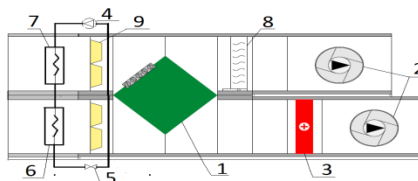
Приточно-вытяжная установка(VS-21-R-PH): 1- перекрестно-точный рекуператор; 2- вентилятор; 3- электронагреватель; 4- компрессор; 5- обратный клапан; 6- испаритель; 7- конденсатор; 8- воздушный клапан; 9- карманный фильтр
